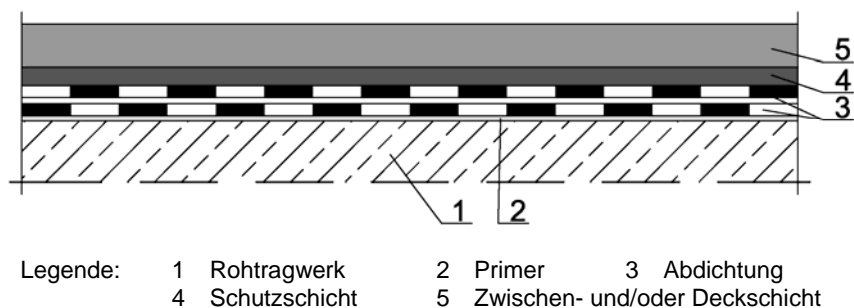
Aufbau einer zweilagigen Brückenabdichtung
